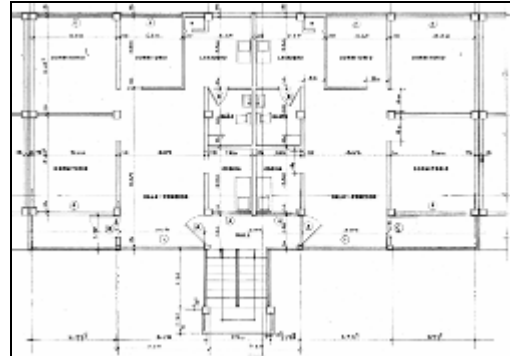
c. Bloque CT-1 Mejorado. Planta
